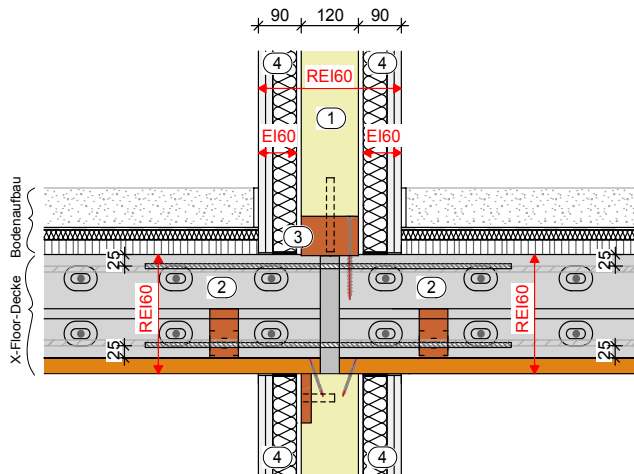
Bauteilzusammenschluss Wohnungstrennwand / Geschossdecke
